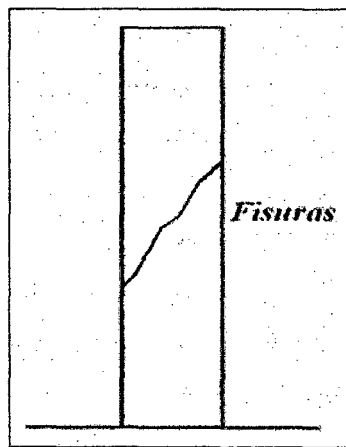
11. Fisuración inclinada en columnas por cortante. Fuente: (Stuardo P., 2008)
